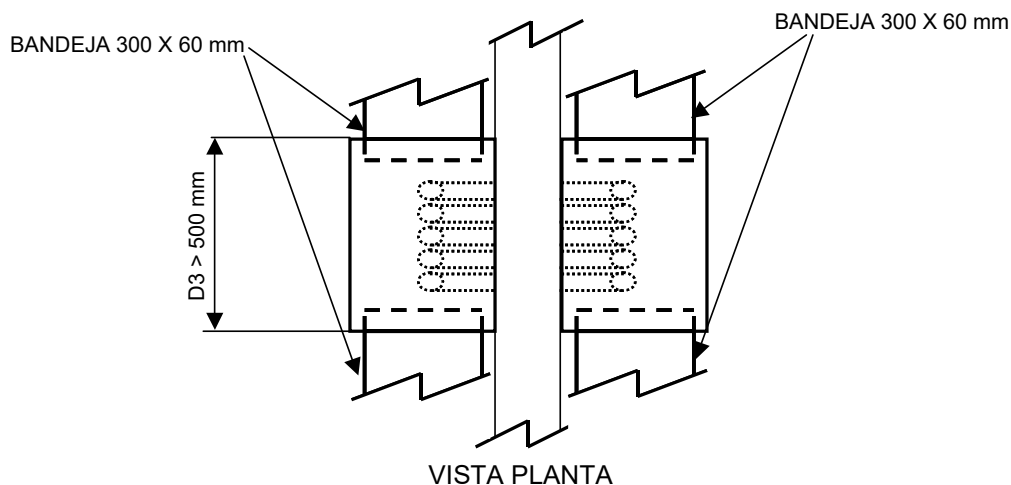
Vista planta de los sifones de paso tierra-aire
